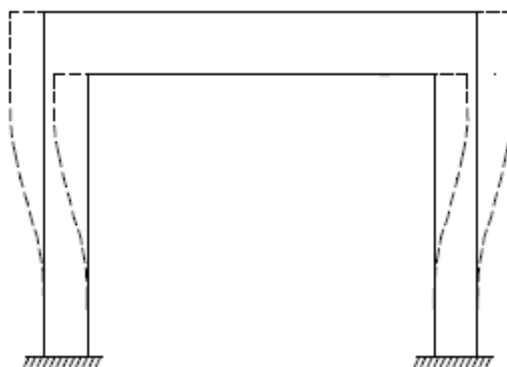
Viga betão armado sujeita à torção e inserida num pórtico simples [116]
